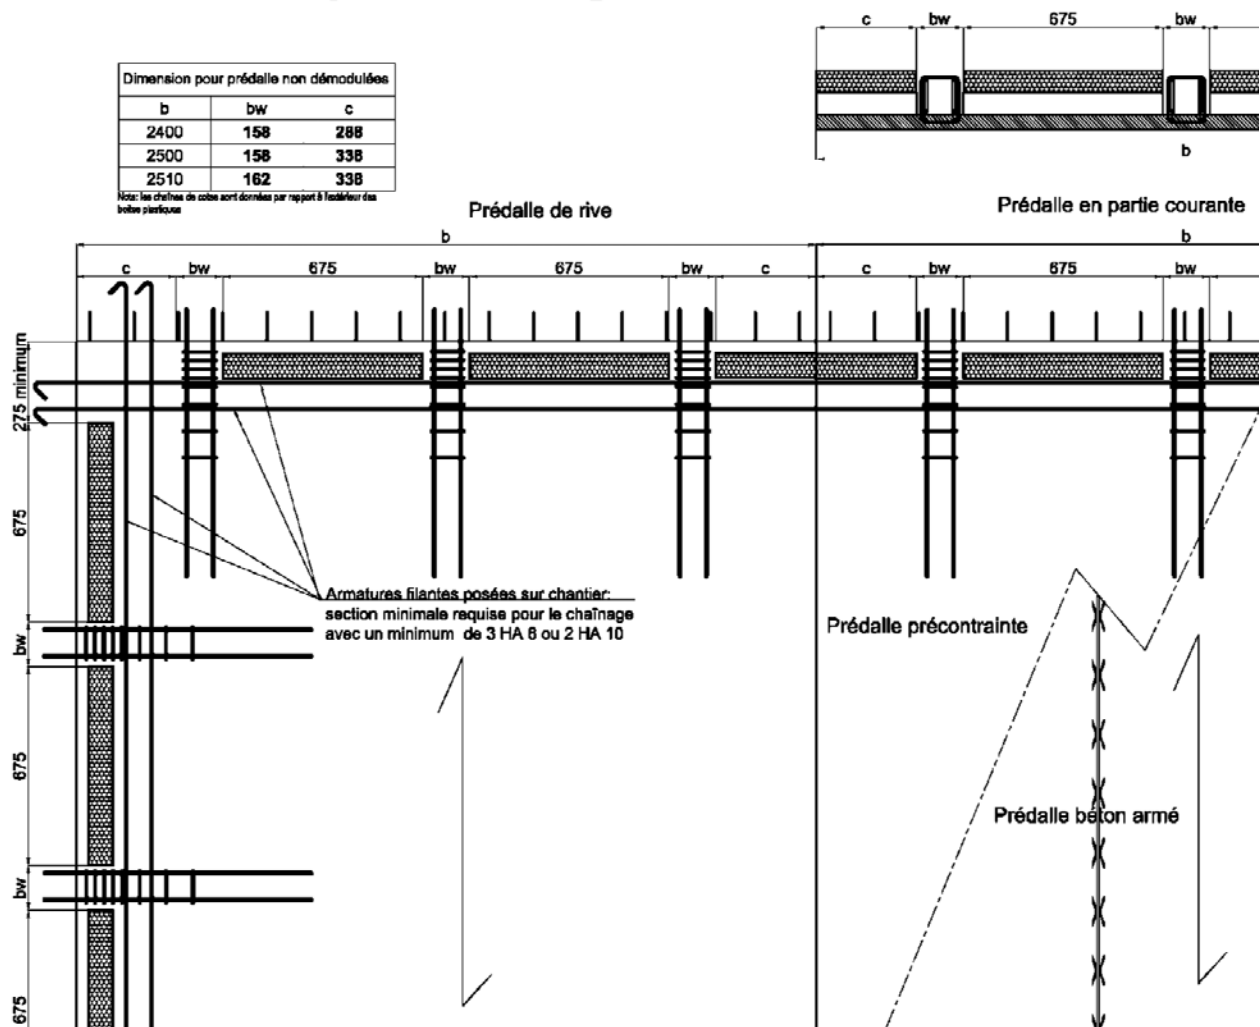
Cas de la prédalle d'angle et d'about - Vue en plan – Coffrage -
